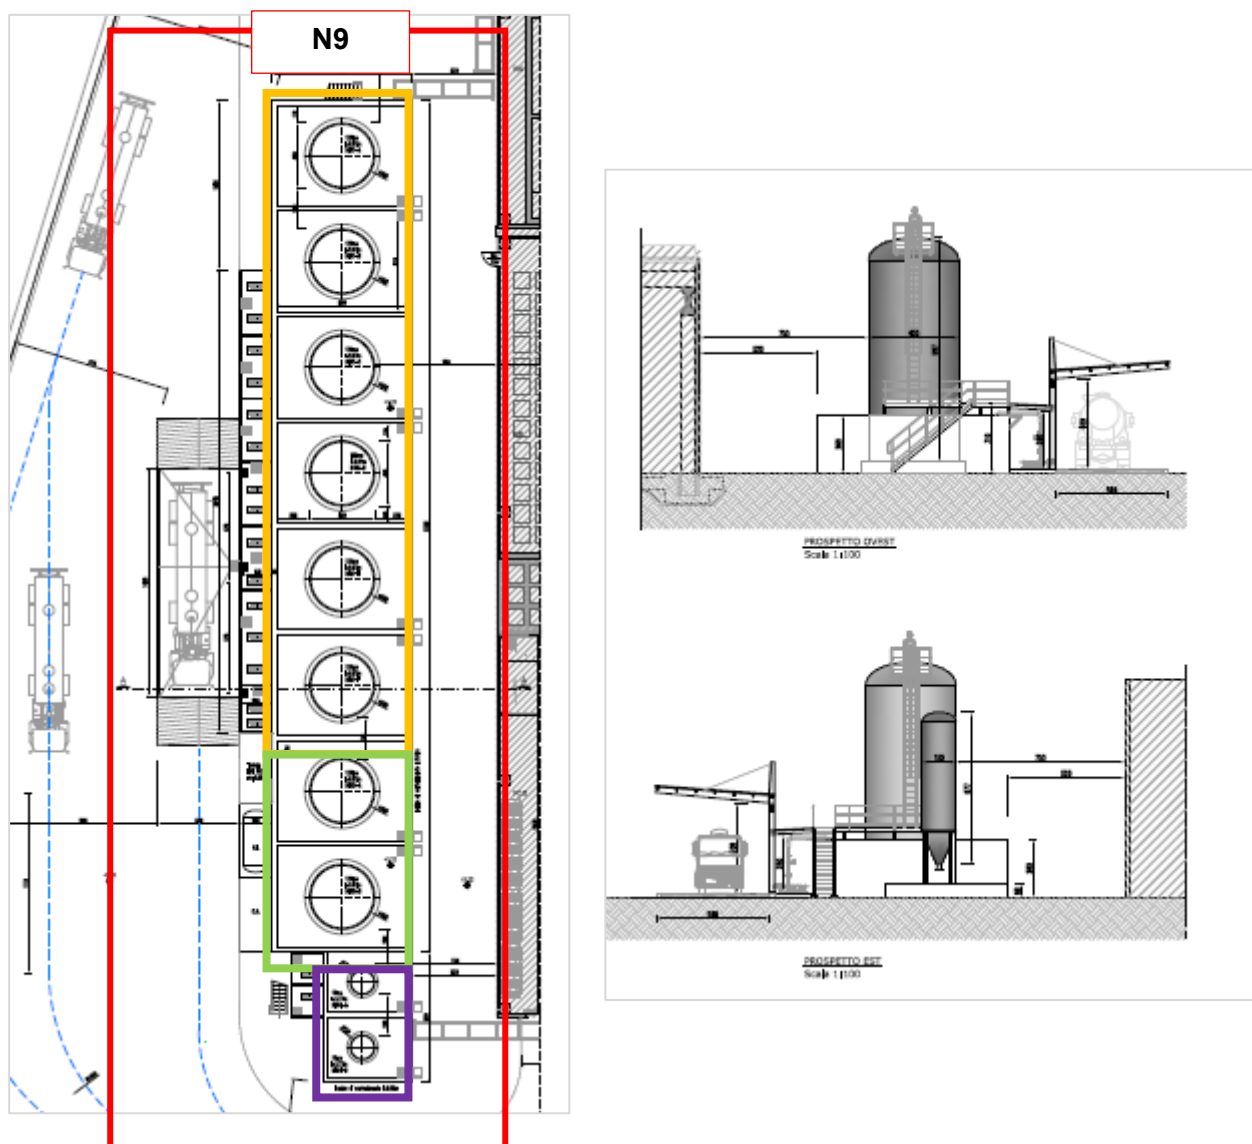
Dettaglio localizzazione Sezione N9 (dx) e prospetti EST/OVEST (sx) (Stralci elaborati CO 05 RA VA 01 D1 PL 70.00 - N9 PIANTE e CO 05 RA VA 01 D1 PL 71.00 - N9 PROSPETTI E SEZIONI )
